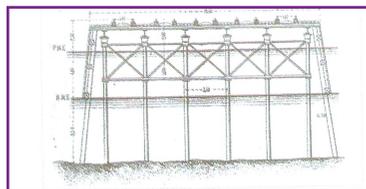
Plano de sección del muelle por la plataforma de embarque. Archivo de los autores.
